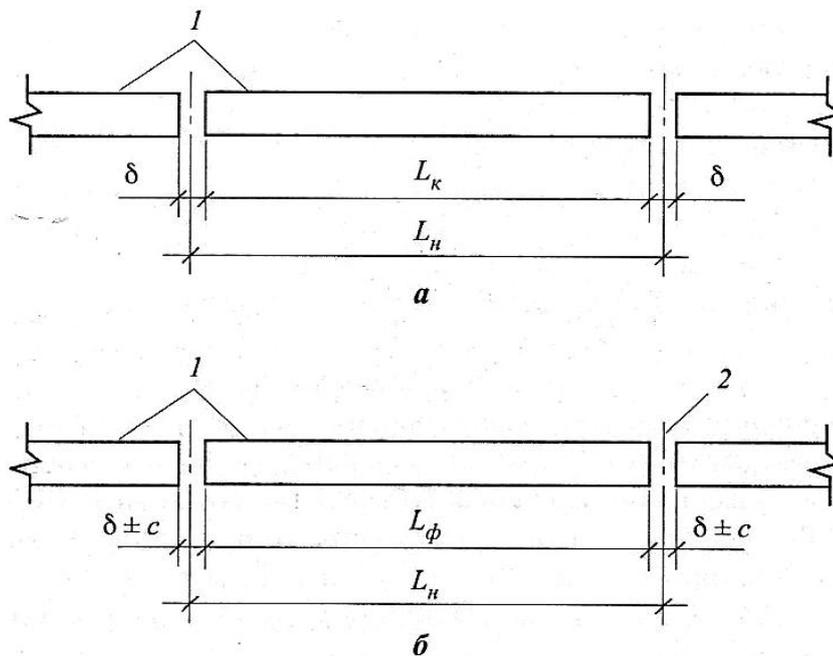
Размеры конструктивных элементов; а- номинальный и конструктивный, б- натурный; 1- конструктивные элементы, 2- зазор
